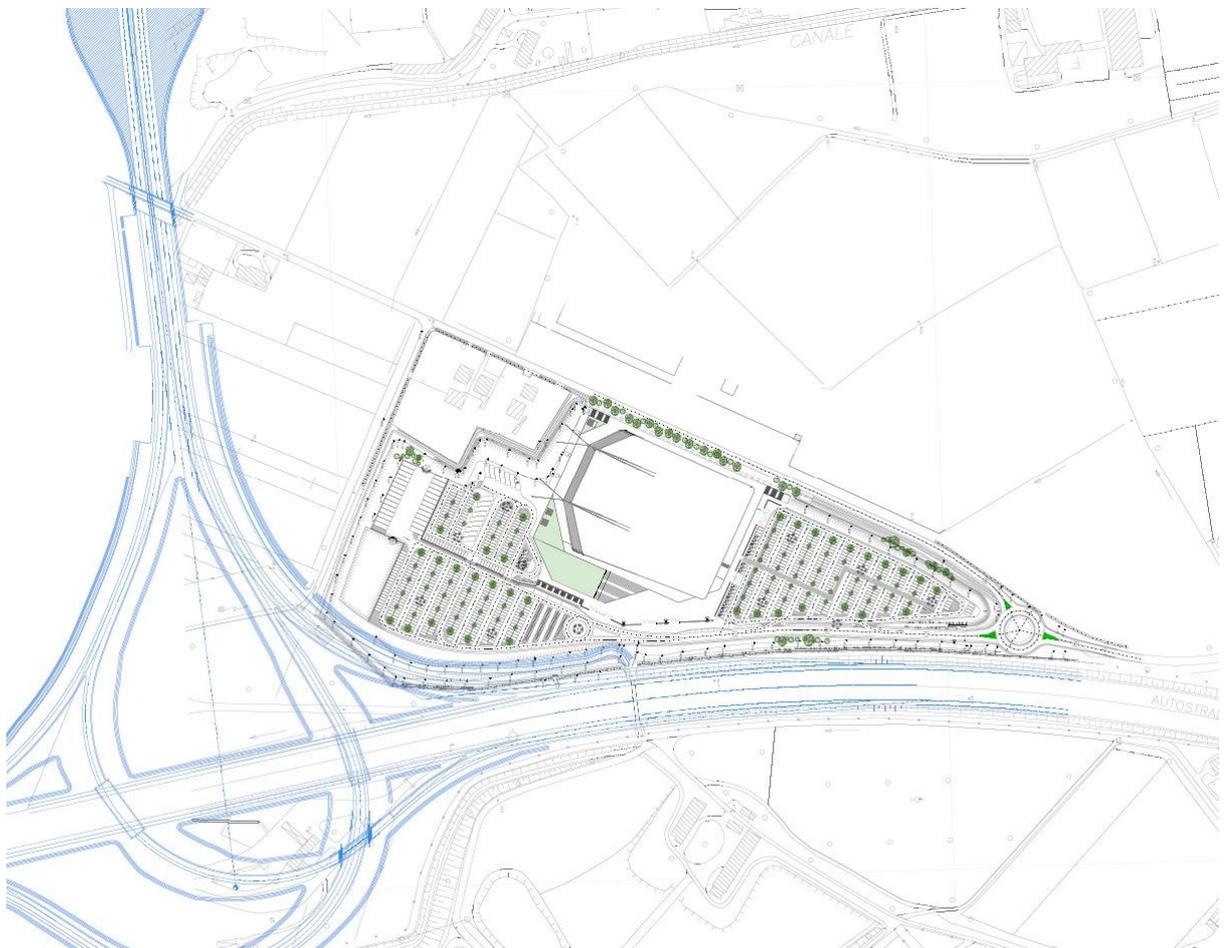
Planimetria di progetto della "Variante Pedemontana"
